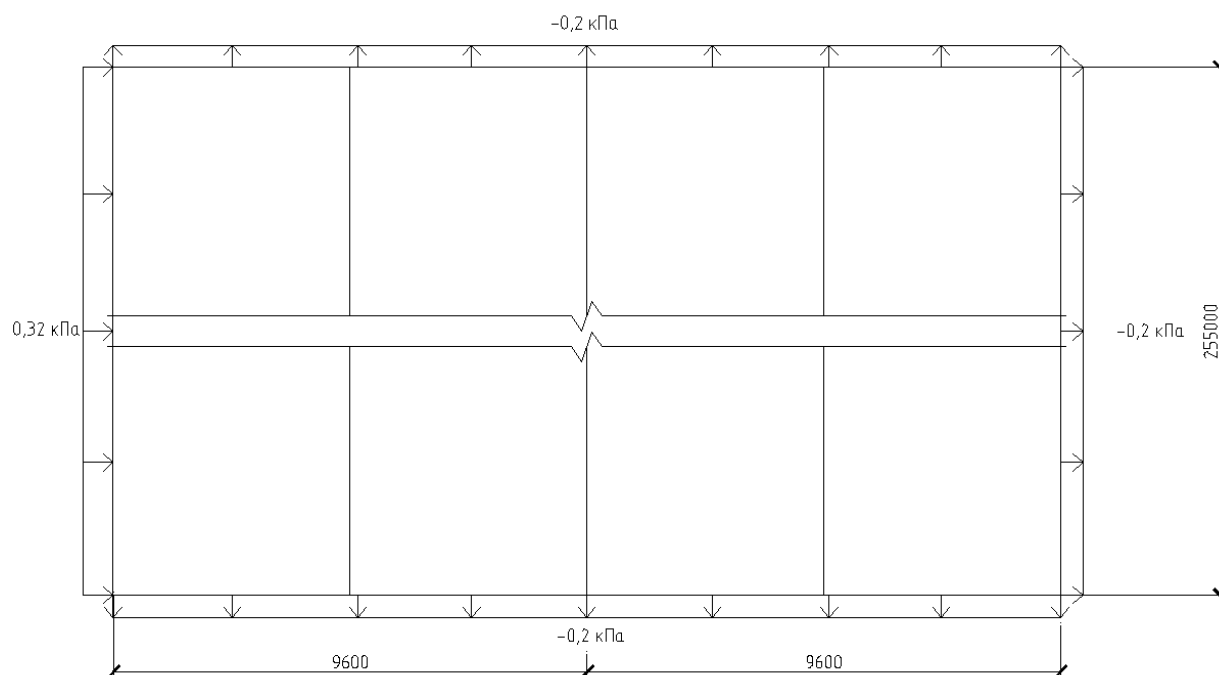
Расчетная схема для сбора ветровой нагрузки
